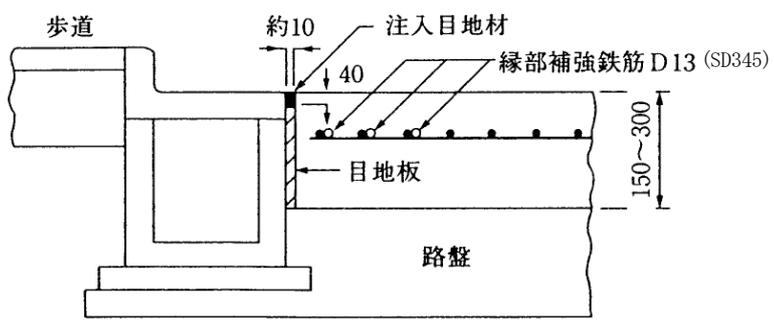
排水溝に接する縦自由縁部の目地構造例 (単位: mm)
